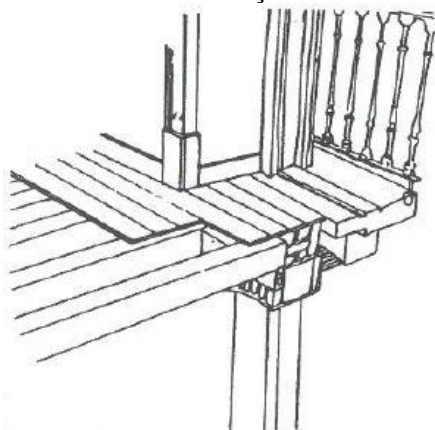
Pormenor de ligação das vigas de pavimento com frontal e paredes exteriores (Appleton, 2003)
